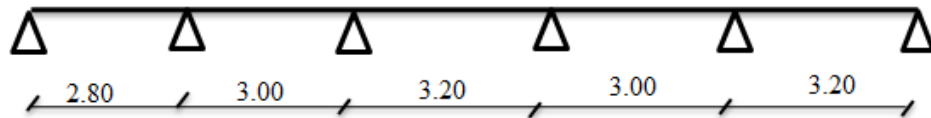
Poutrelle type 02 (Plancher RDC et étages courants)
